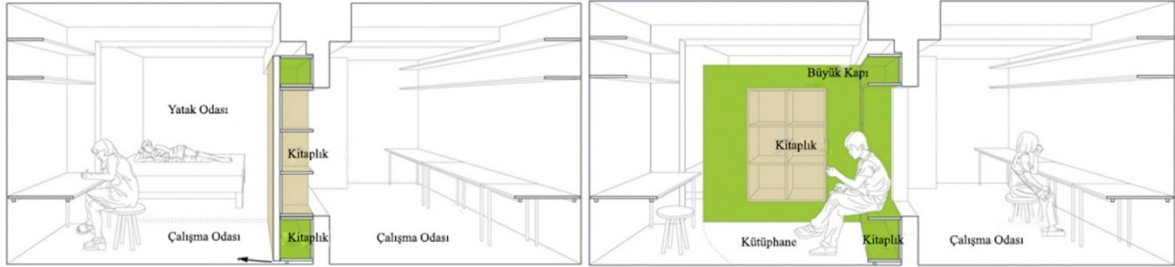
Tokyo Switch Apartmanı Planı Kaynak: (Ryohei Hamada, 2010)
